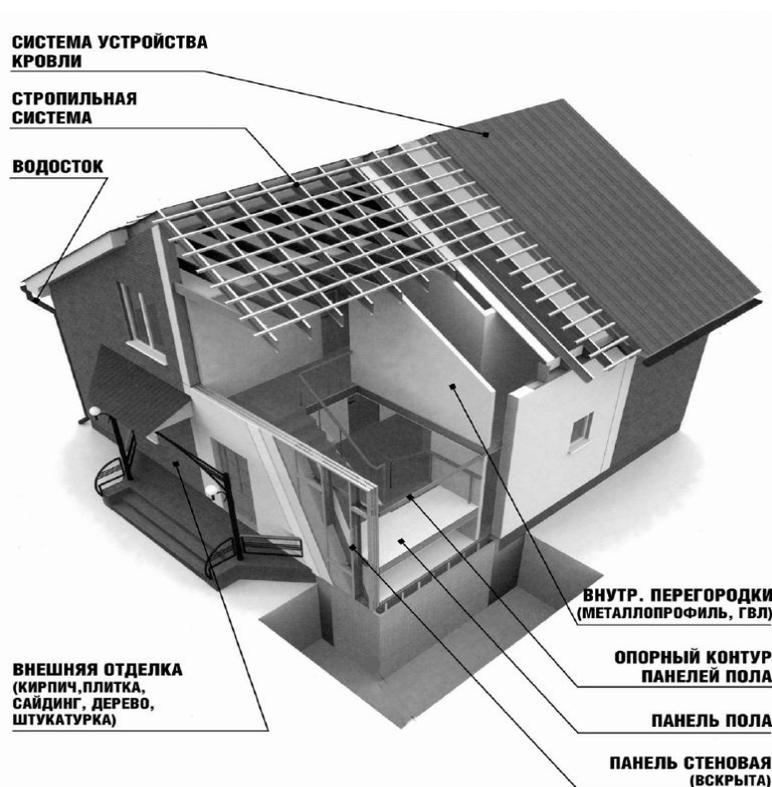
Принципиальная схема устройства здания на основе каркаса из термопрофиля
